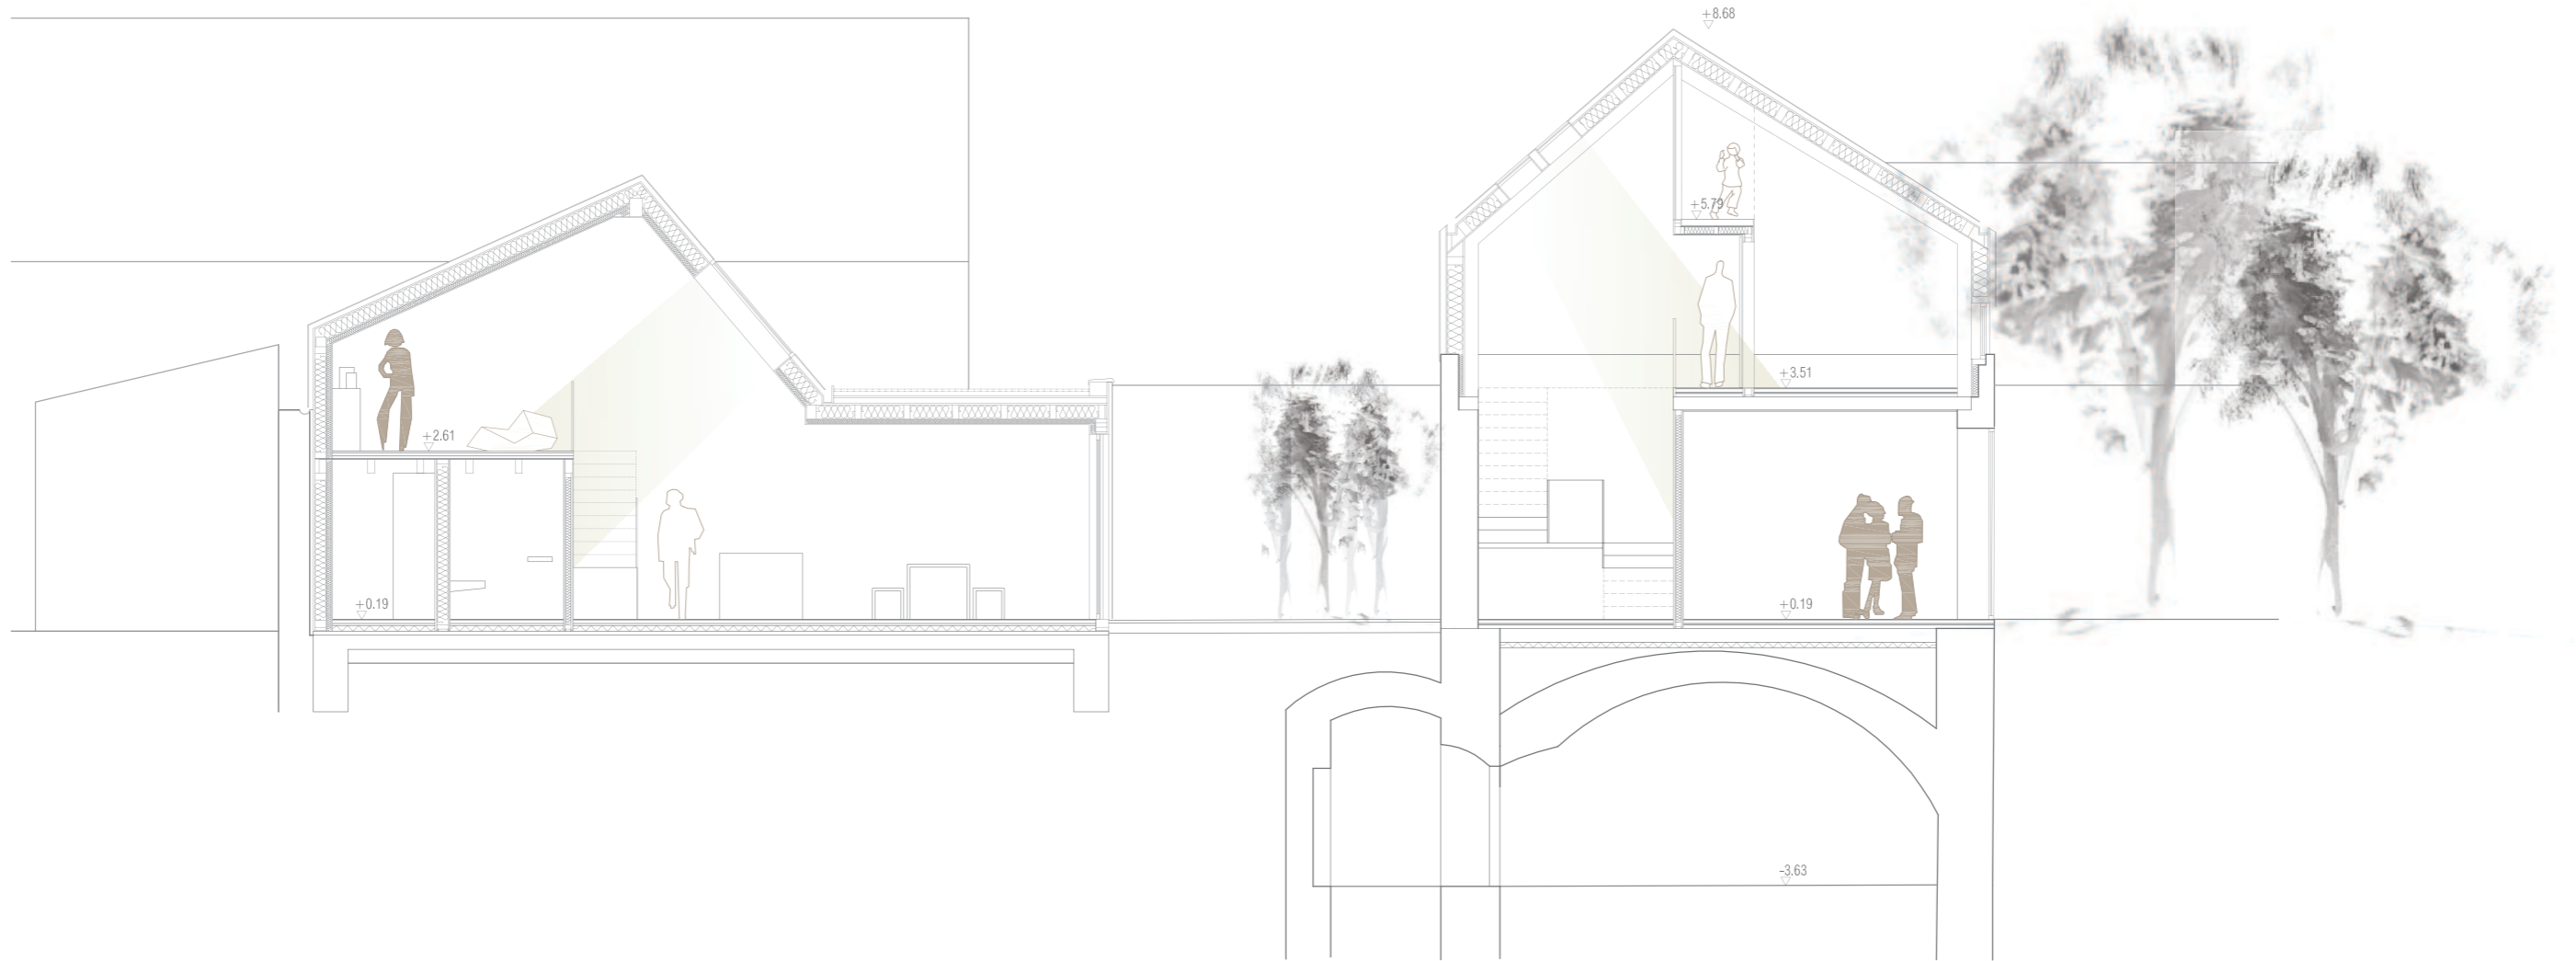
Gebäude C_ELTERNHAUS_Erweiterung_Schnitt EE Maßstab 1:100
